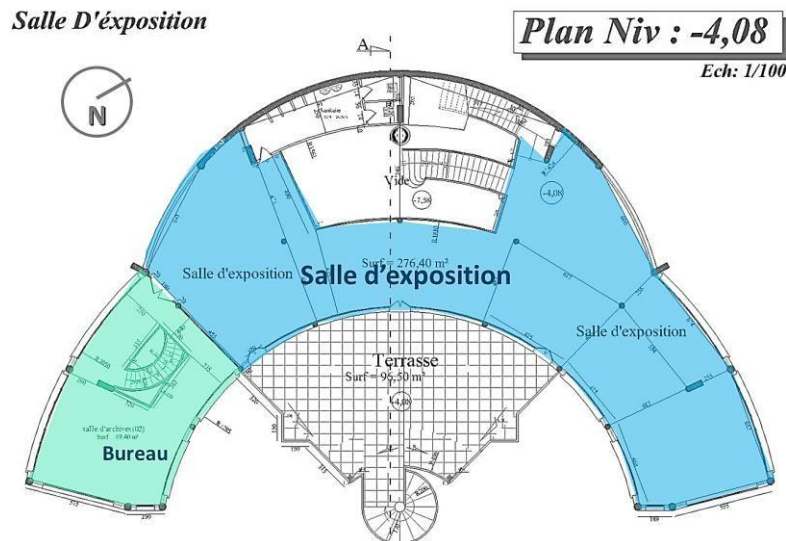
Plan de la salle d'exposition du musée el moudjahid. (Source :
